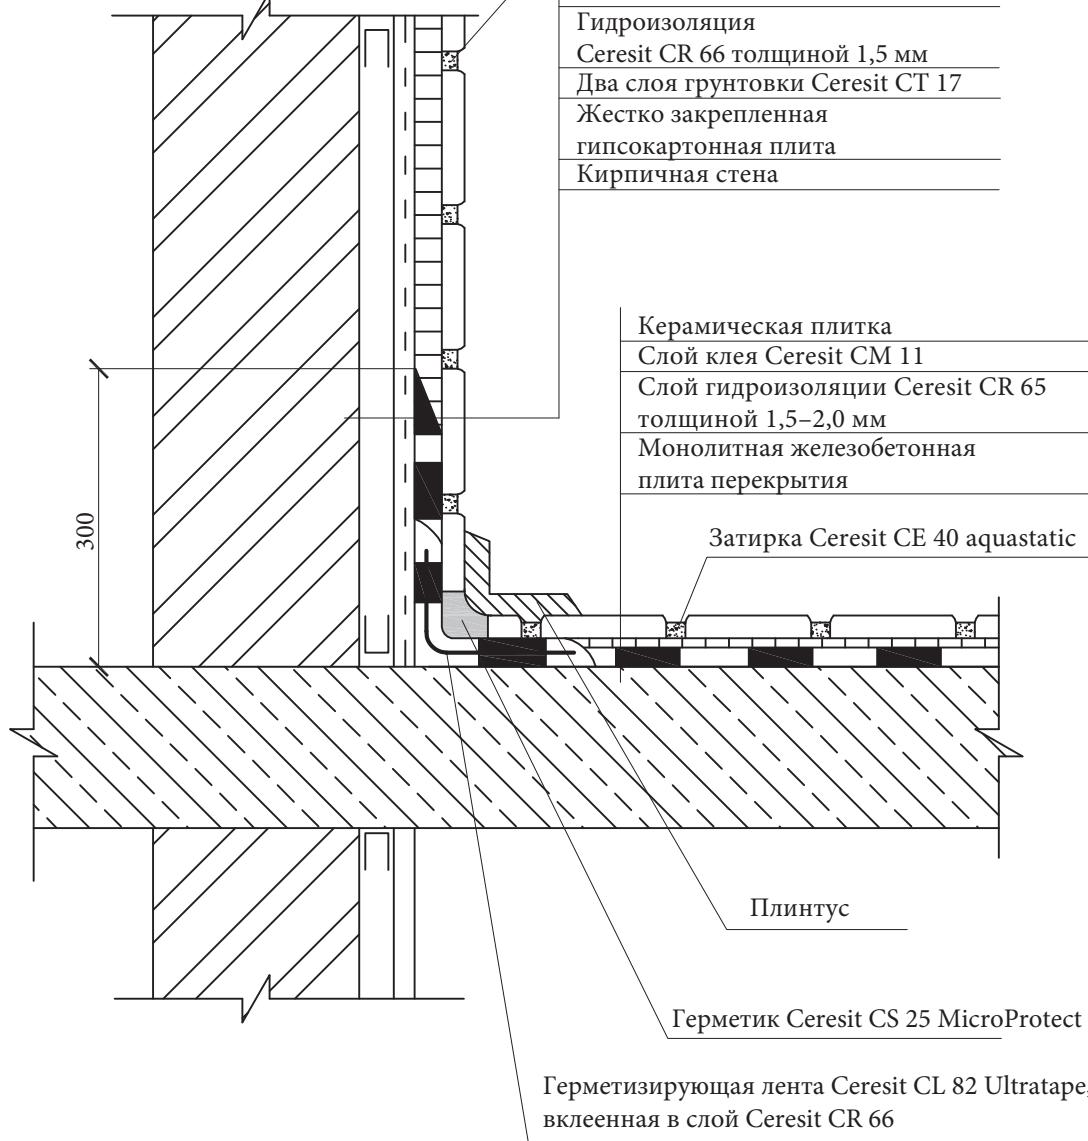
Конструкция системы гидроизоляции бытовых душевых, ванных комнат, санузлов, прачечных помещений, кухонь (стены выравнены влагостойкими плитами)
